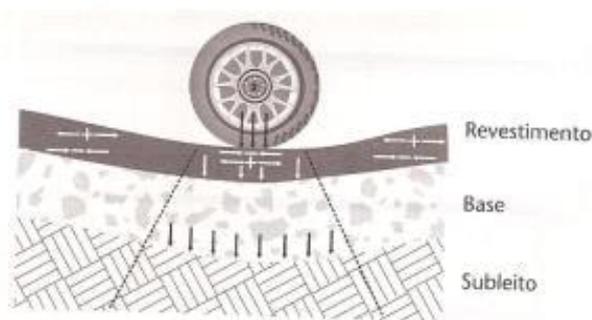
Seção de pavimento flexível (Balbo, 2007)
